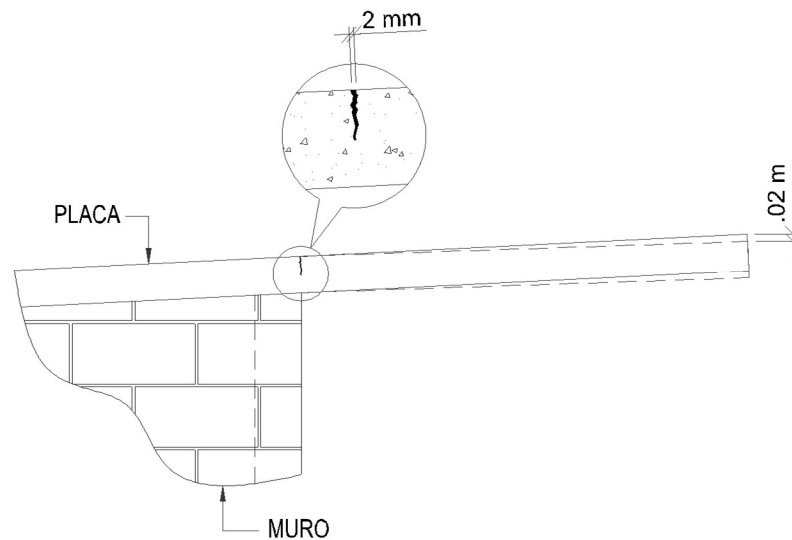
Detalle fisura y deformación voladizo placa de cubierta (archivo propio)
